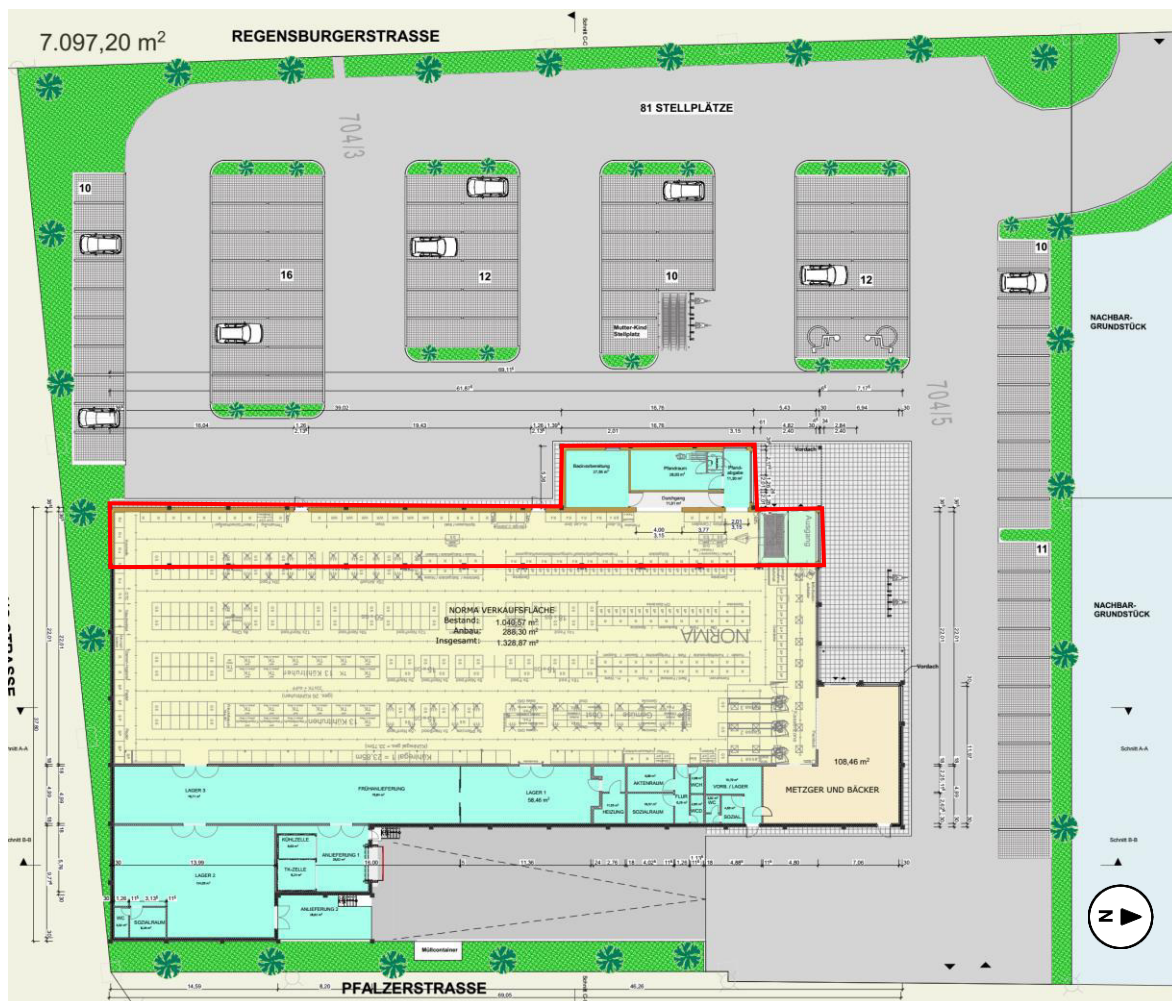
Auszug aus dem Grundrissplan mit Freianlagenplan vom 21.06.2022
